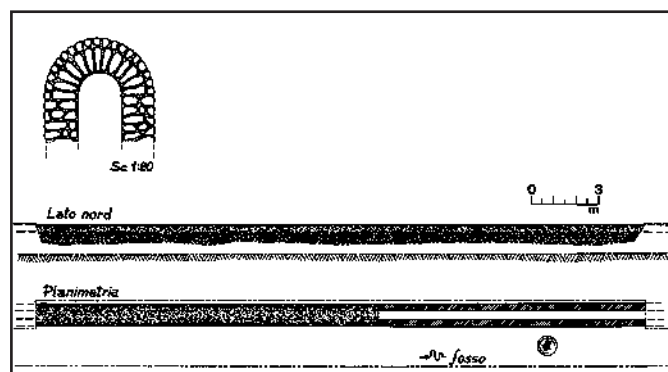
Restituzione grafica dell'acquedotto secondario con veduta e sezione (dallo scavo del 1962; disegno P. Barale).
